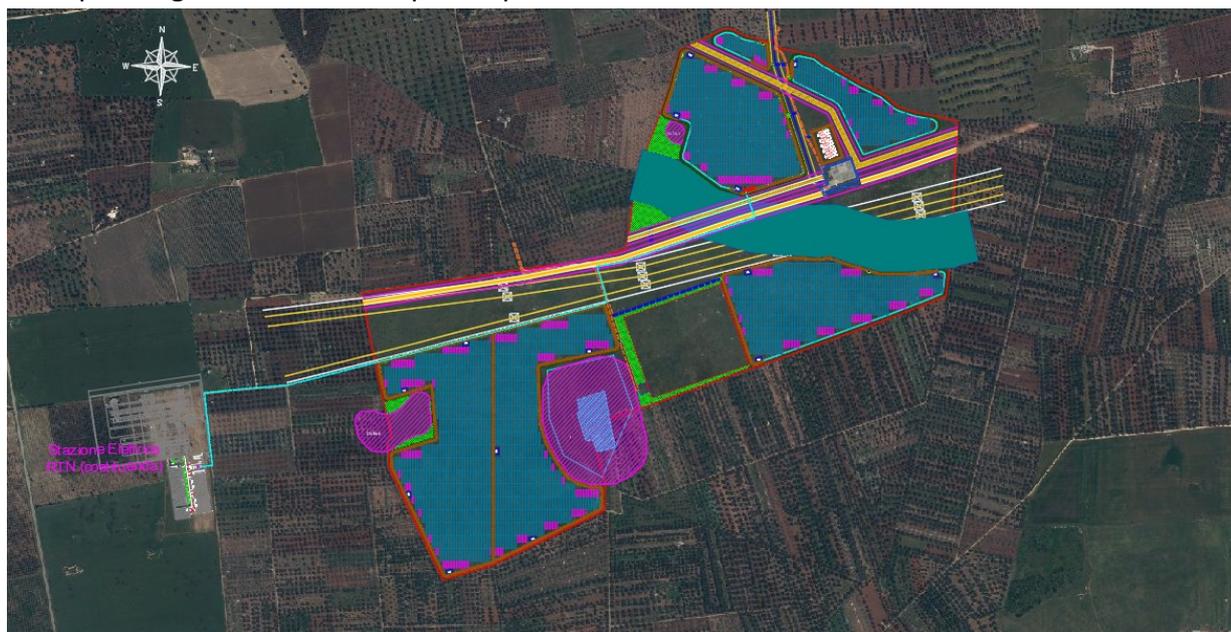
andamento su Ortofoto del cavidotto MT che collega l'impianto alla stazione elettrica
